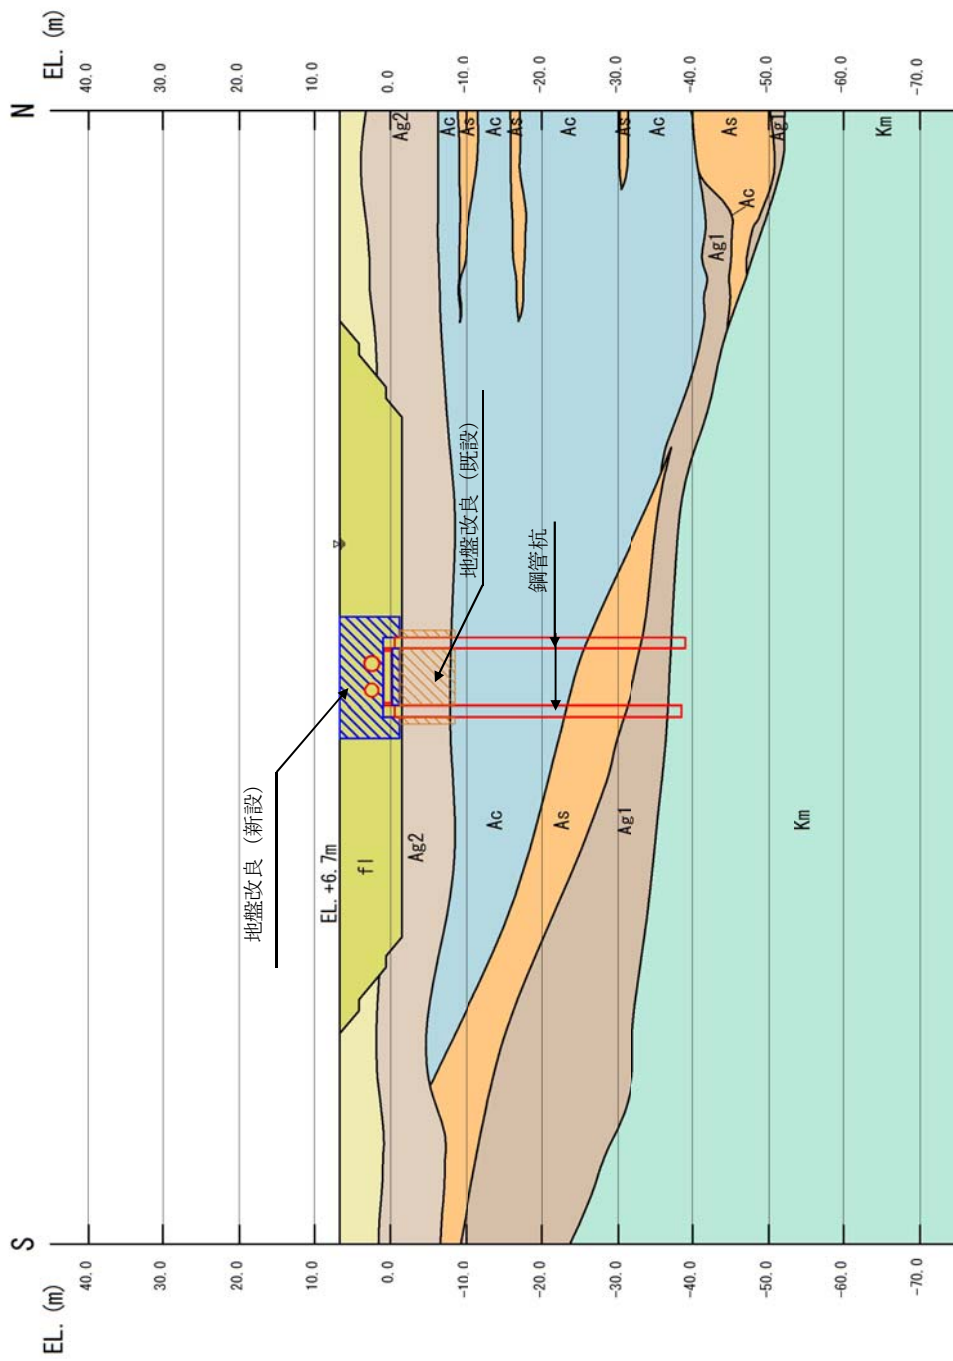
(2) 屋外二重管の横断面図 (B-B断面) (区間 I 候補断面①)
